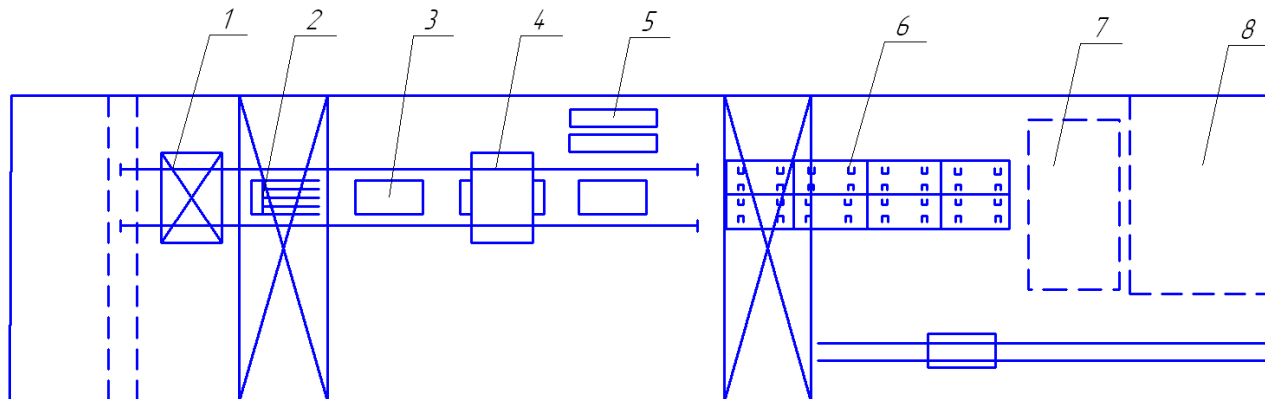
Агрегатно-поточная линия по производству многопустотных плит перекрытий:
